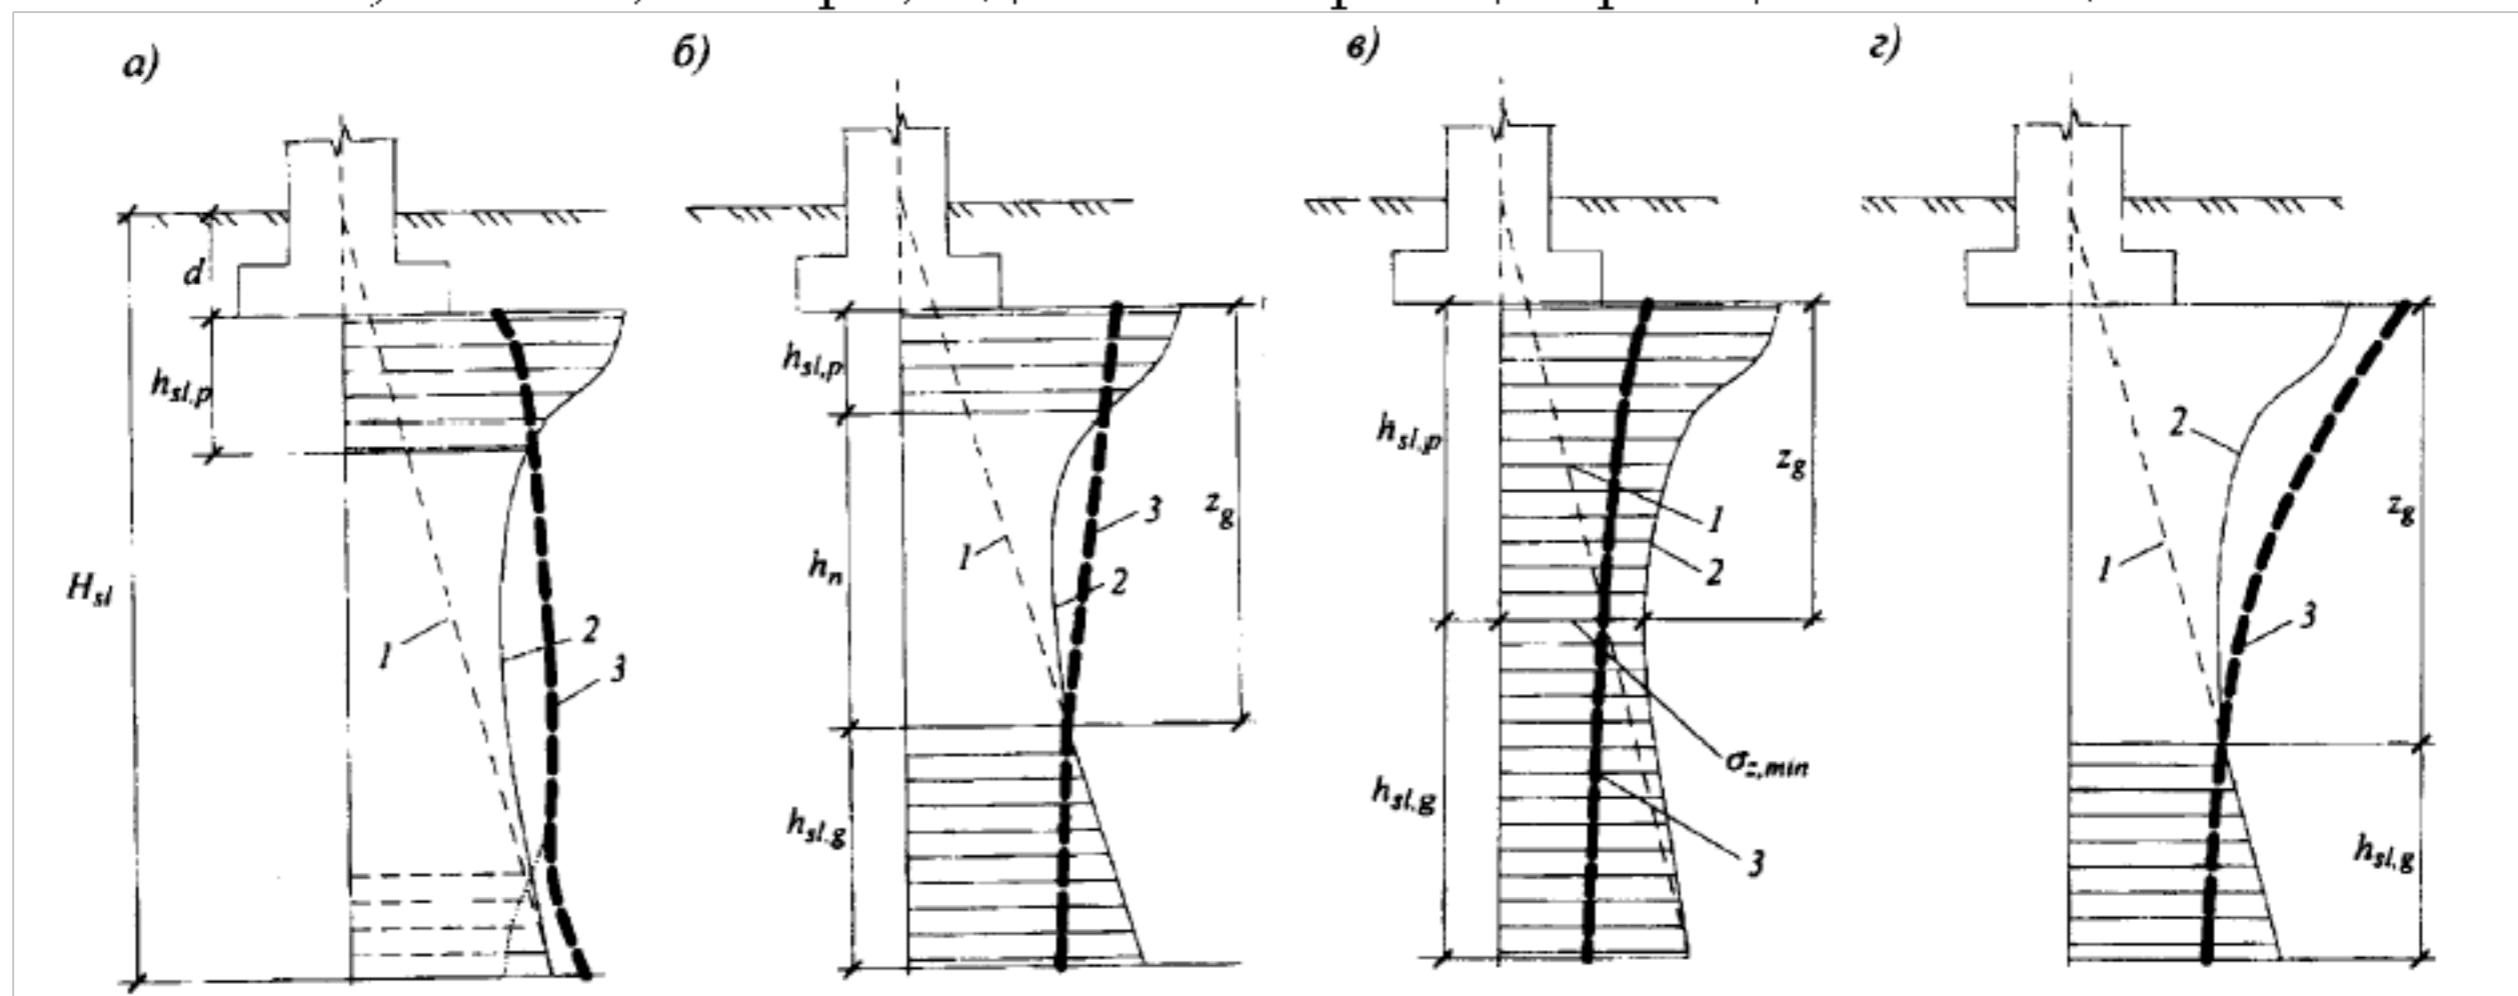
Схемы к расчету просадок основания фундаментов: а - просадка от собственного веса  $ssl,g$  отсутствует (не превышает 5 см), возможна только просадка от внешней нагрузки  $ssl,p$  в верхней зоне просадки  $h_{sl,p}$  (I тип грунтовых условий); б, в, г - возможна просадка от собственного веса  $ssl,g$  в нижней зоне просадки  $h_{sl,g}$  начиная с глубины  $z_g$  (II тип грунтовых условий); б - верхняя и нижняя зоны просадки не сливаются, имеется нейтральная зона  $hp$ ; в - верхняя и нижняя зоны просадки сливаются; г - просадка от внешней нагрузки отсутствует; 1 - вертикальные напряжения от собственного веса грунта  $-z_g$ ; 2 - суммарные вертикальные напряжения от внешней нагрузки и собственного веса грунта  $-z = \square z_p + -z_g$ ; 3 - изменение с глубиной начального просадочного давления  $psl$ ;  $H_{sl}$  - толщина слоя просадочных грунтов (просадочная толща);  $d$  - глубина заложения фундамента
